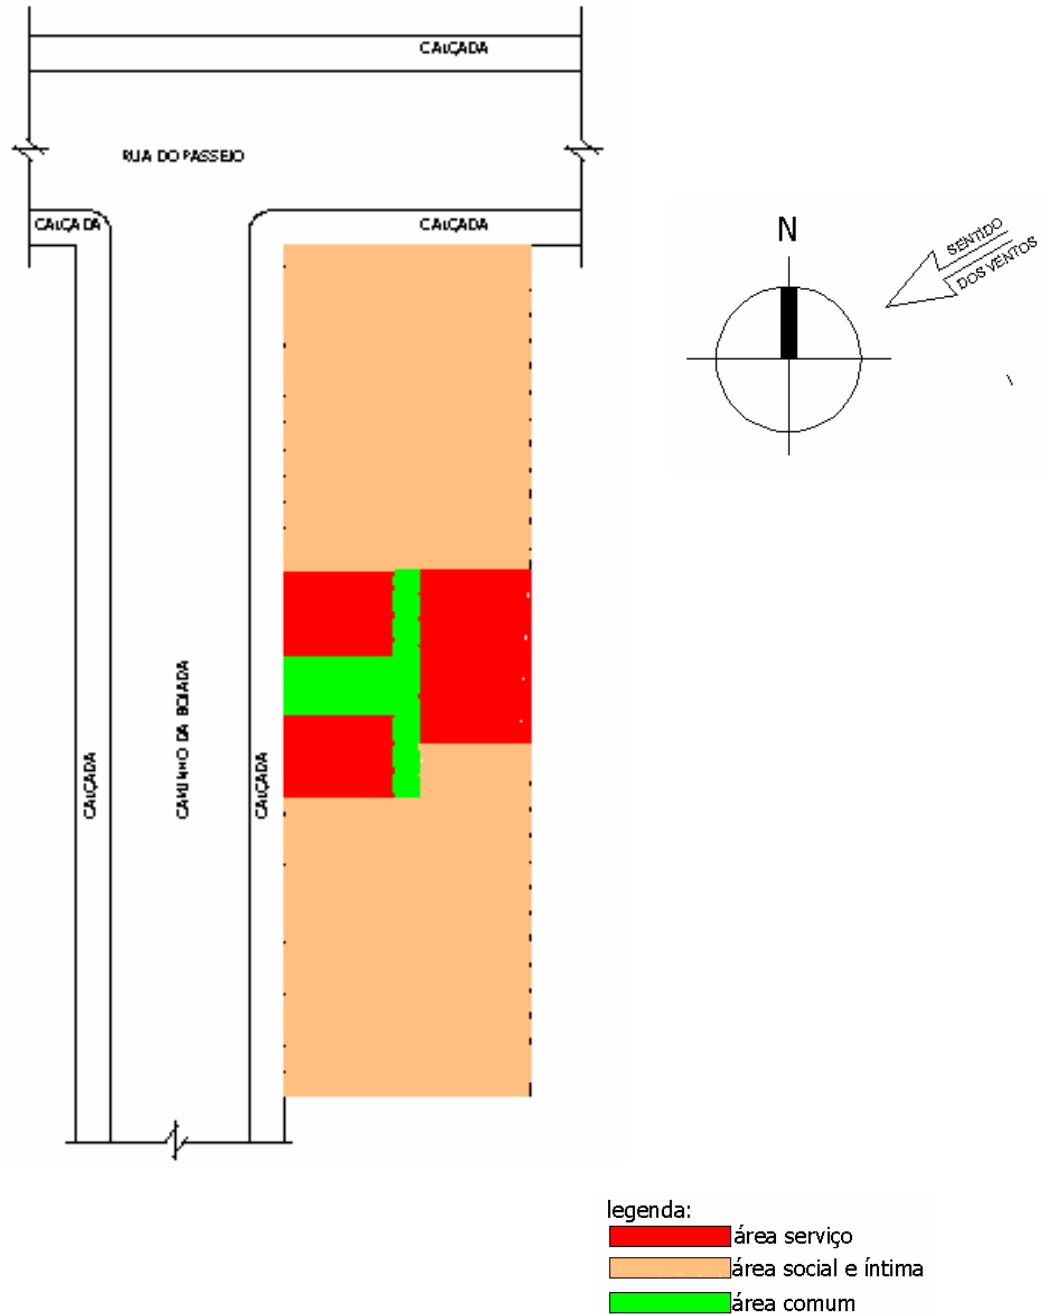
Planta baixa ilustrativa do Pavimento Tipo
